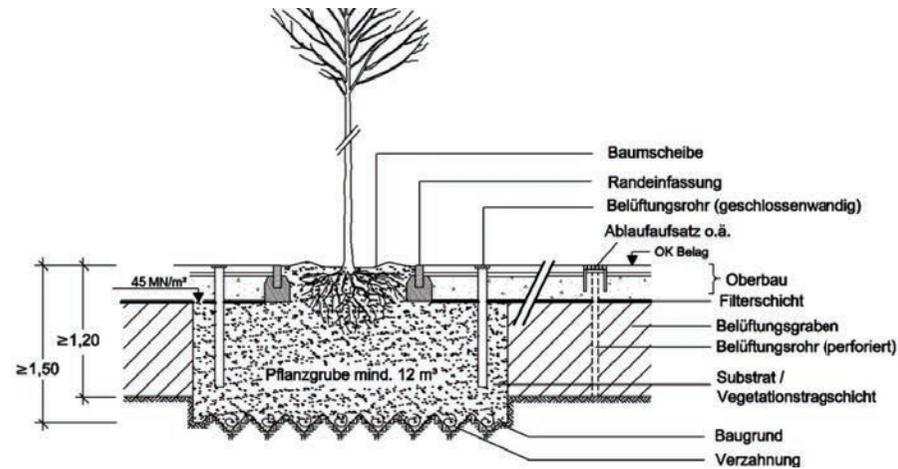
Pflanzgrubenbauweise 2 mit einer überbauten Pflanzgrube und einer Grabenbelüftung nach FLL/FGSV
